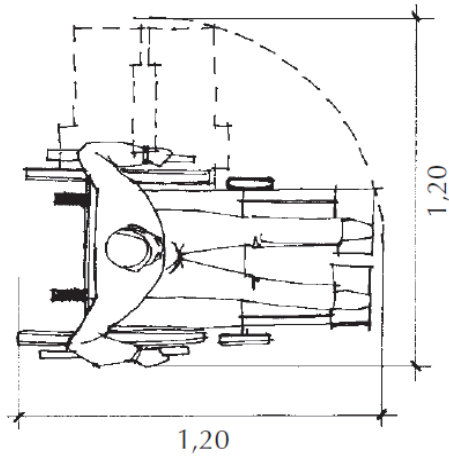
Espaço de Rotação mínimo para movimento de 90° (SMPED, 2008).
